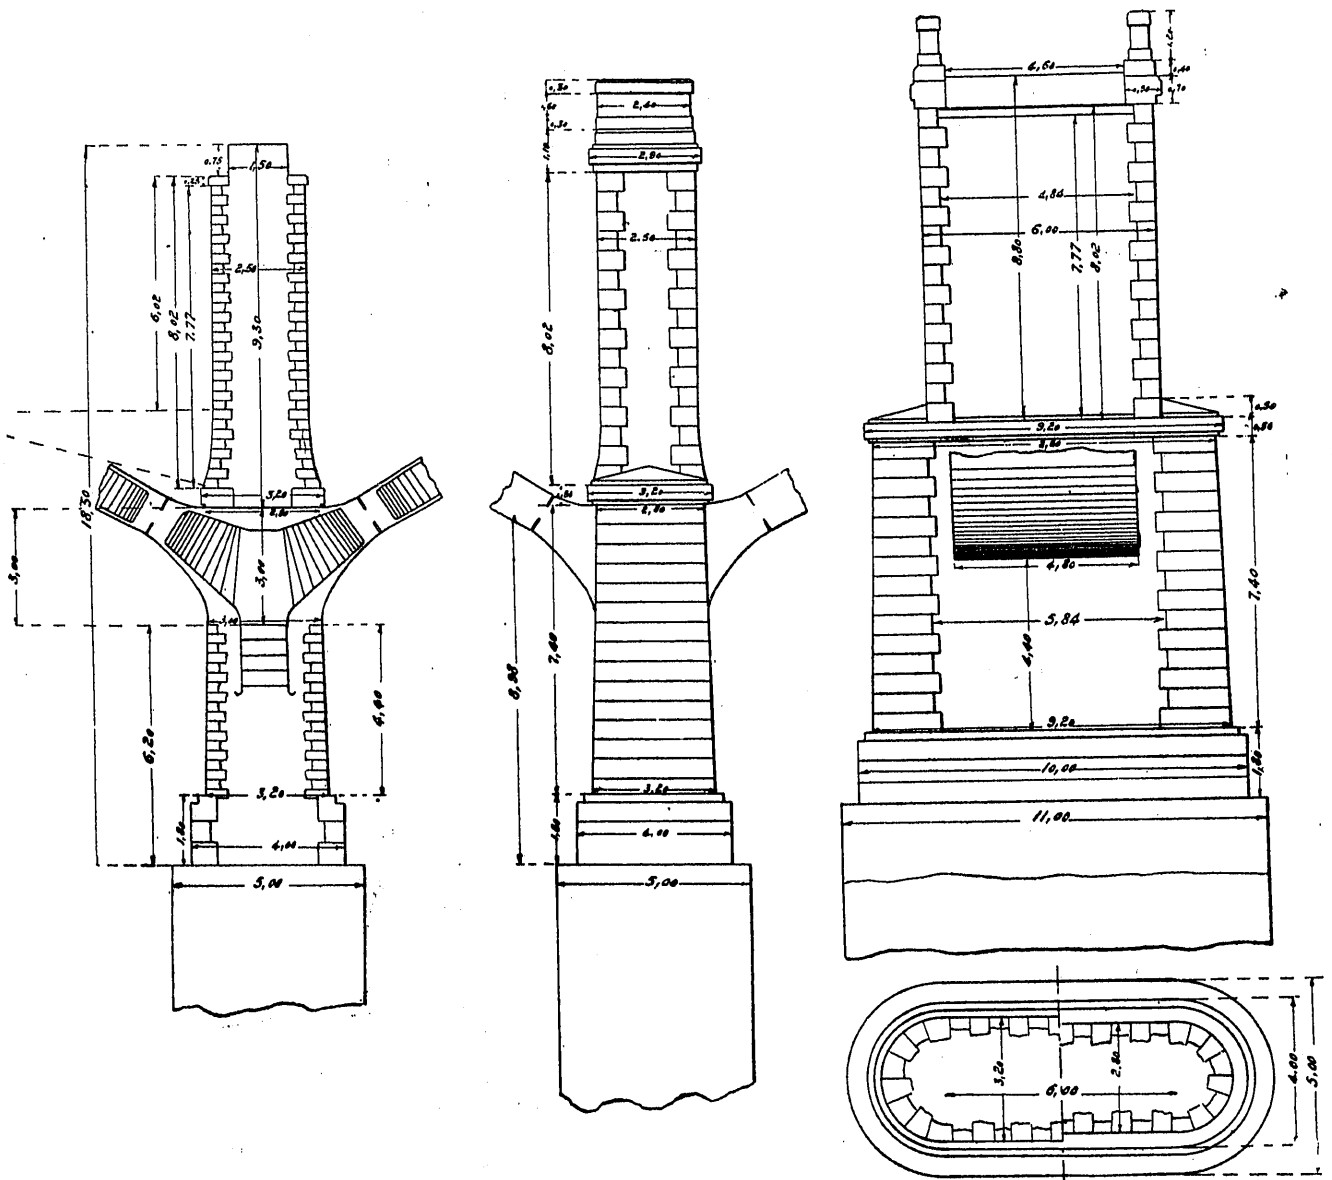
ª Corte longitudinal, frente y alzado lateral y planta de las pilas.
